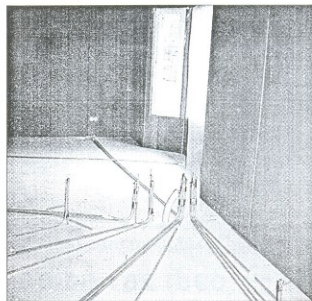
Теплоизоляция пола жилого дома с применением плит из ППС
